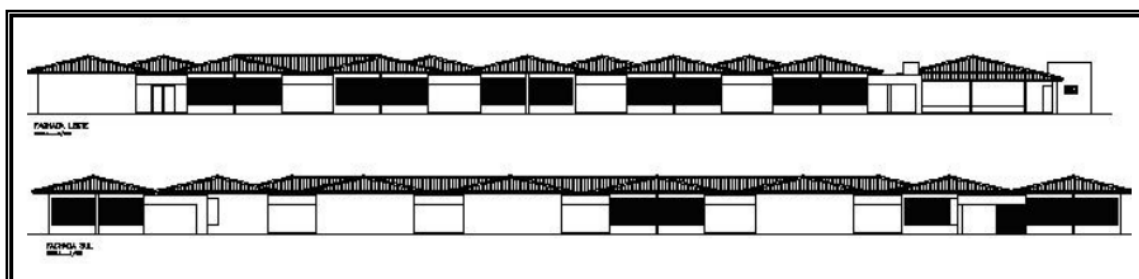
Fachadas Leste e Sul – Escola Santos Dumont.
